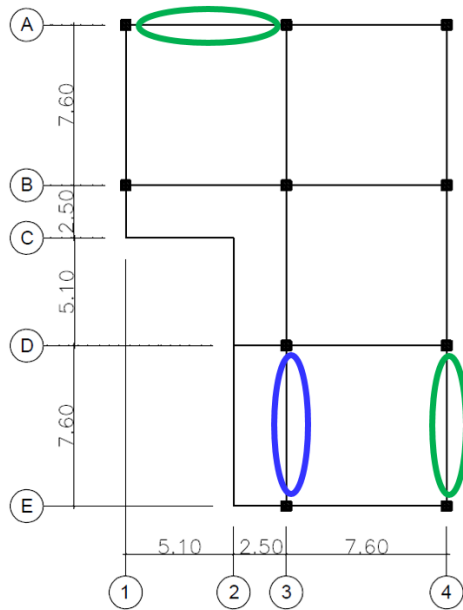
En verde se señala las vigas con fisuras longitudinales y en azul la viga con acero corroído expuesto
